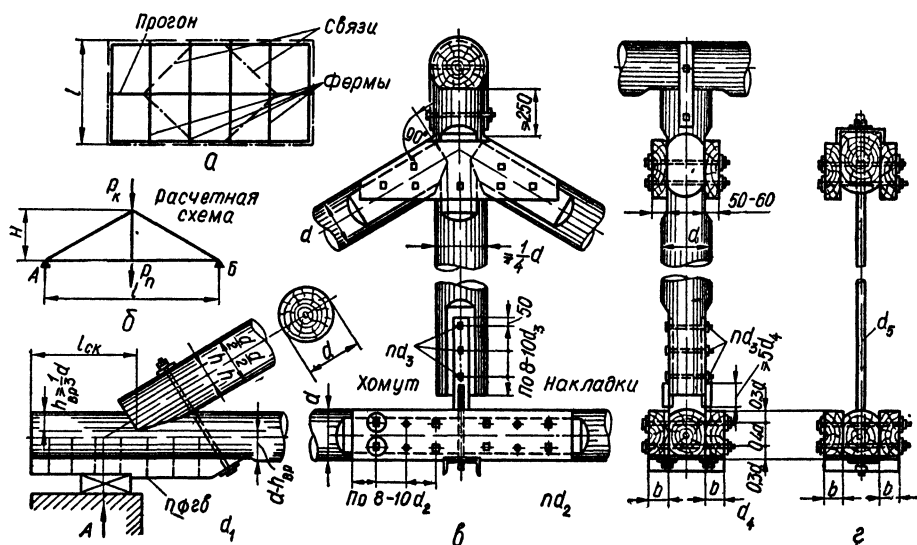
Конструкция треугольной фермы из бревен с одной подвеской:
